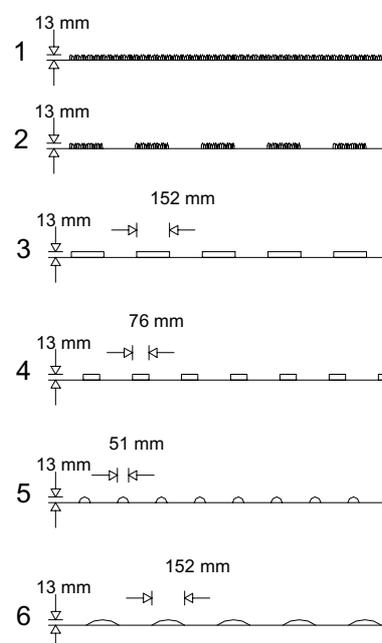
FRANJAS TRANSVERSALES DE ALERTA (Fuente: IHT, DoT, 1987)
